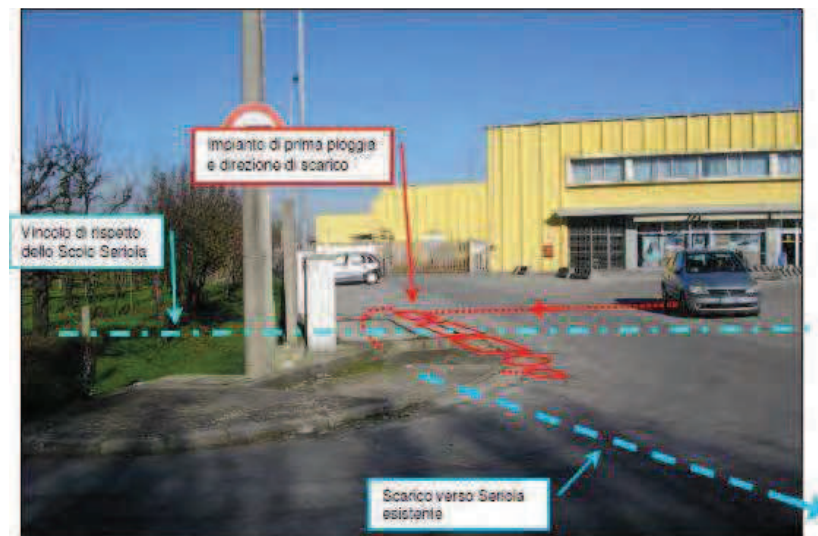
Foto prospetto sud - da via Bastie verso nord: vista del sedime di installazione dell'impianto di prima pioggia
